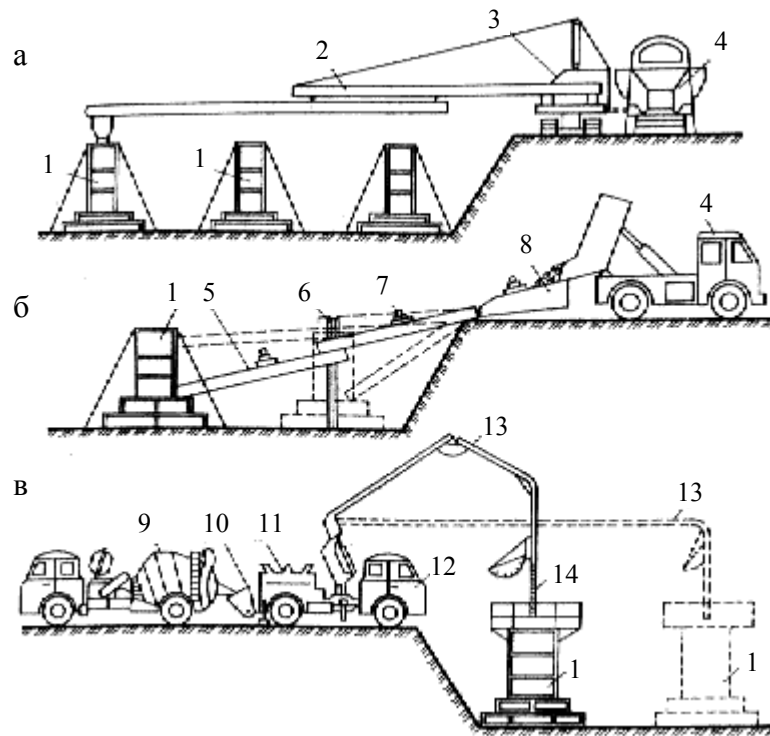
Схеми бетонування: а – самохідними бетоноукладальниками; б – за допомогою віброжолобів; в – автобетононасосами; 1 – бетоновані фундаменти; 2 – телескопічна стріла бетоноукладача; 3 – бетоноукладач; 4 – самоскид; 5 – віброжолоб; 6 – стояк; 7 – вібратор; 8 – віброживильник; 9 – автобетонозмішувач; 10 – приймальний бункер; 11 – бетононасос; 12 – базовий автомобіль; 13 – стріла; 14 – гнучкий рукав
